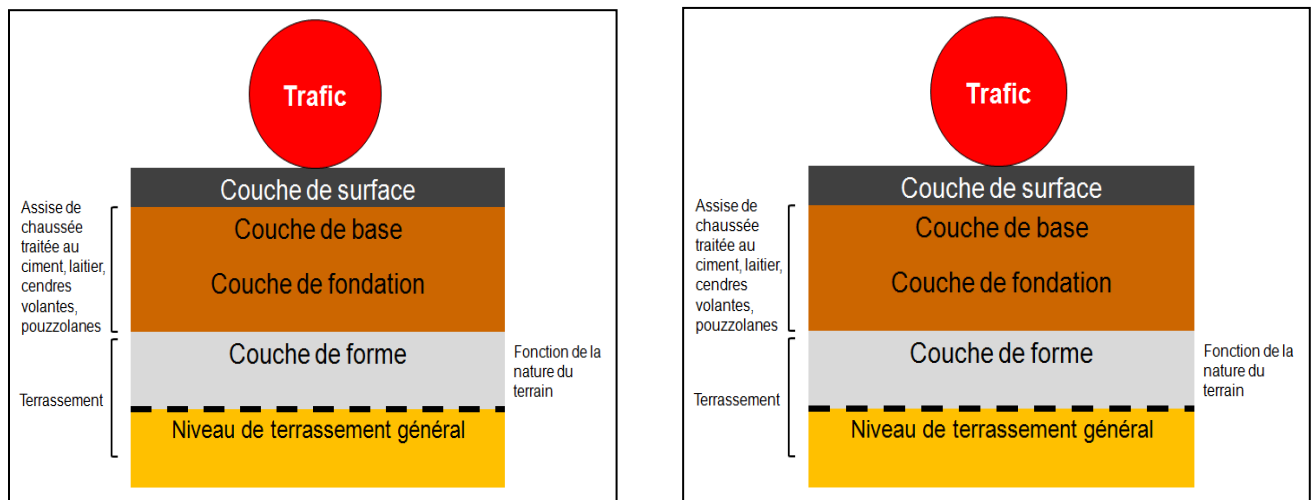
Structure type d'une chaussée semi-rigide.
